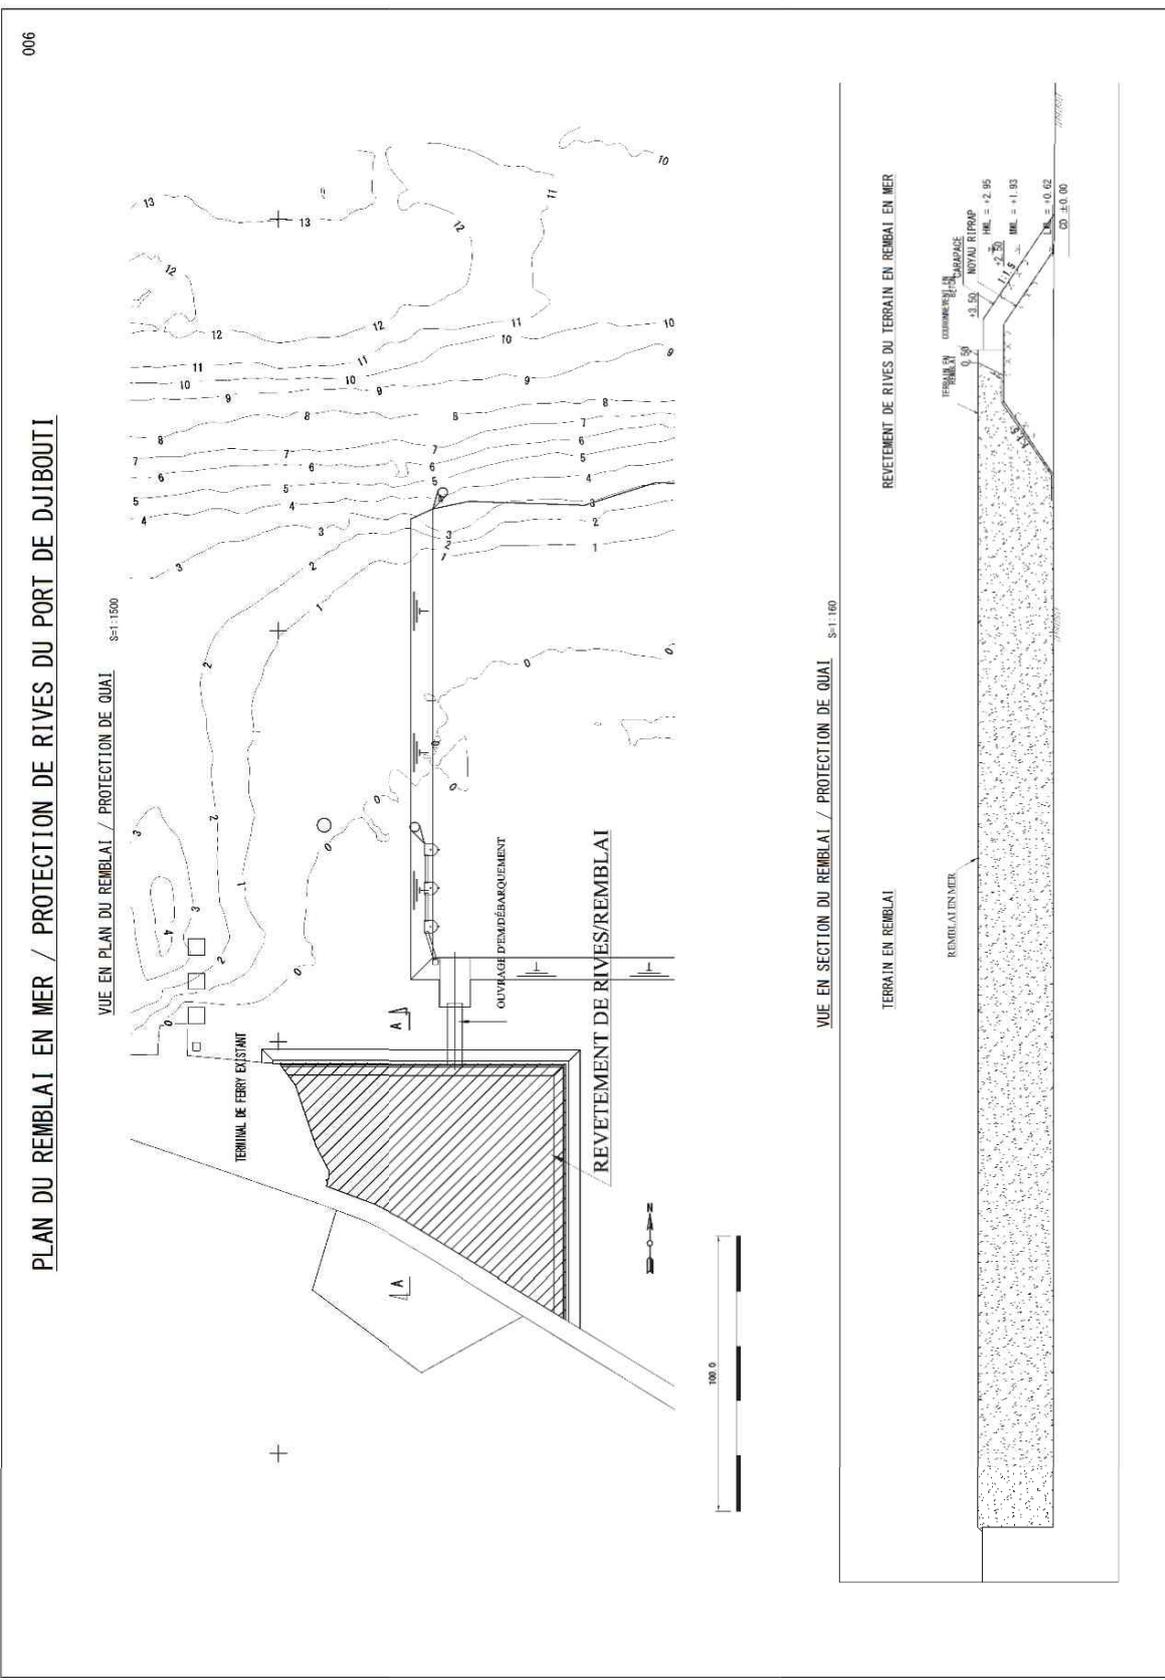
Plan du revêtement de rives du remblaiement en mer du Port de Djibouti
